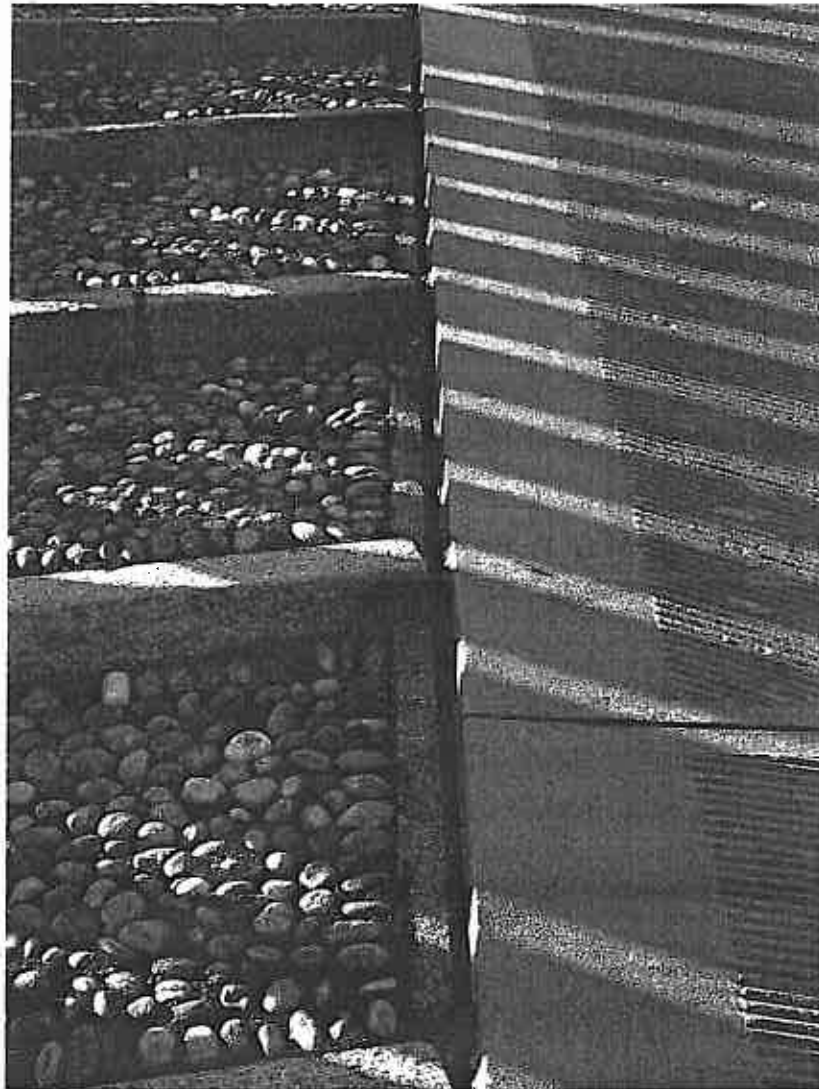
particolare della fessura di distacco tra la scalinata e la pavimentazione in calcestruzzo della strada di accesso al cimitero
